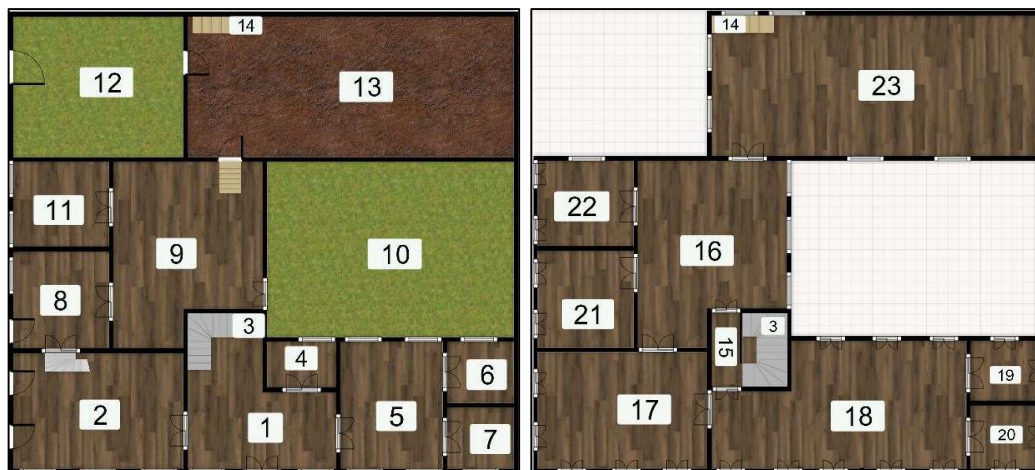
Idealização da planta baixa (C) em "U" apresentando ambos os pavimentos. Fonte: Autor, 2022.
